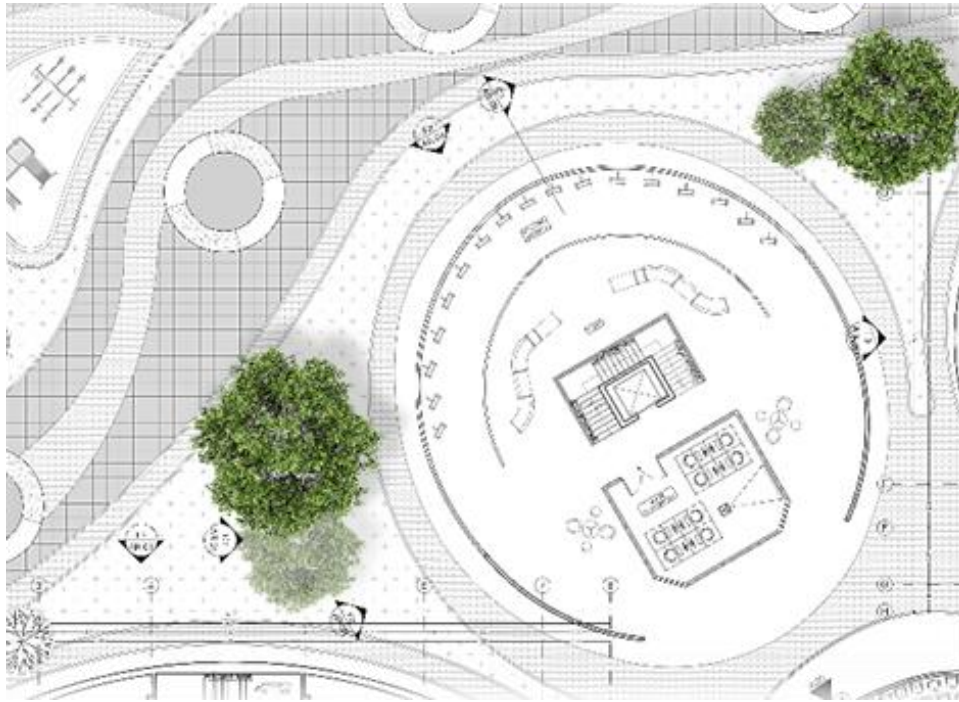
Planta primer piso zona de muse histórico. Elaboración propia.
